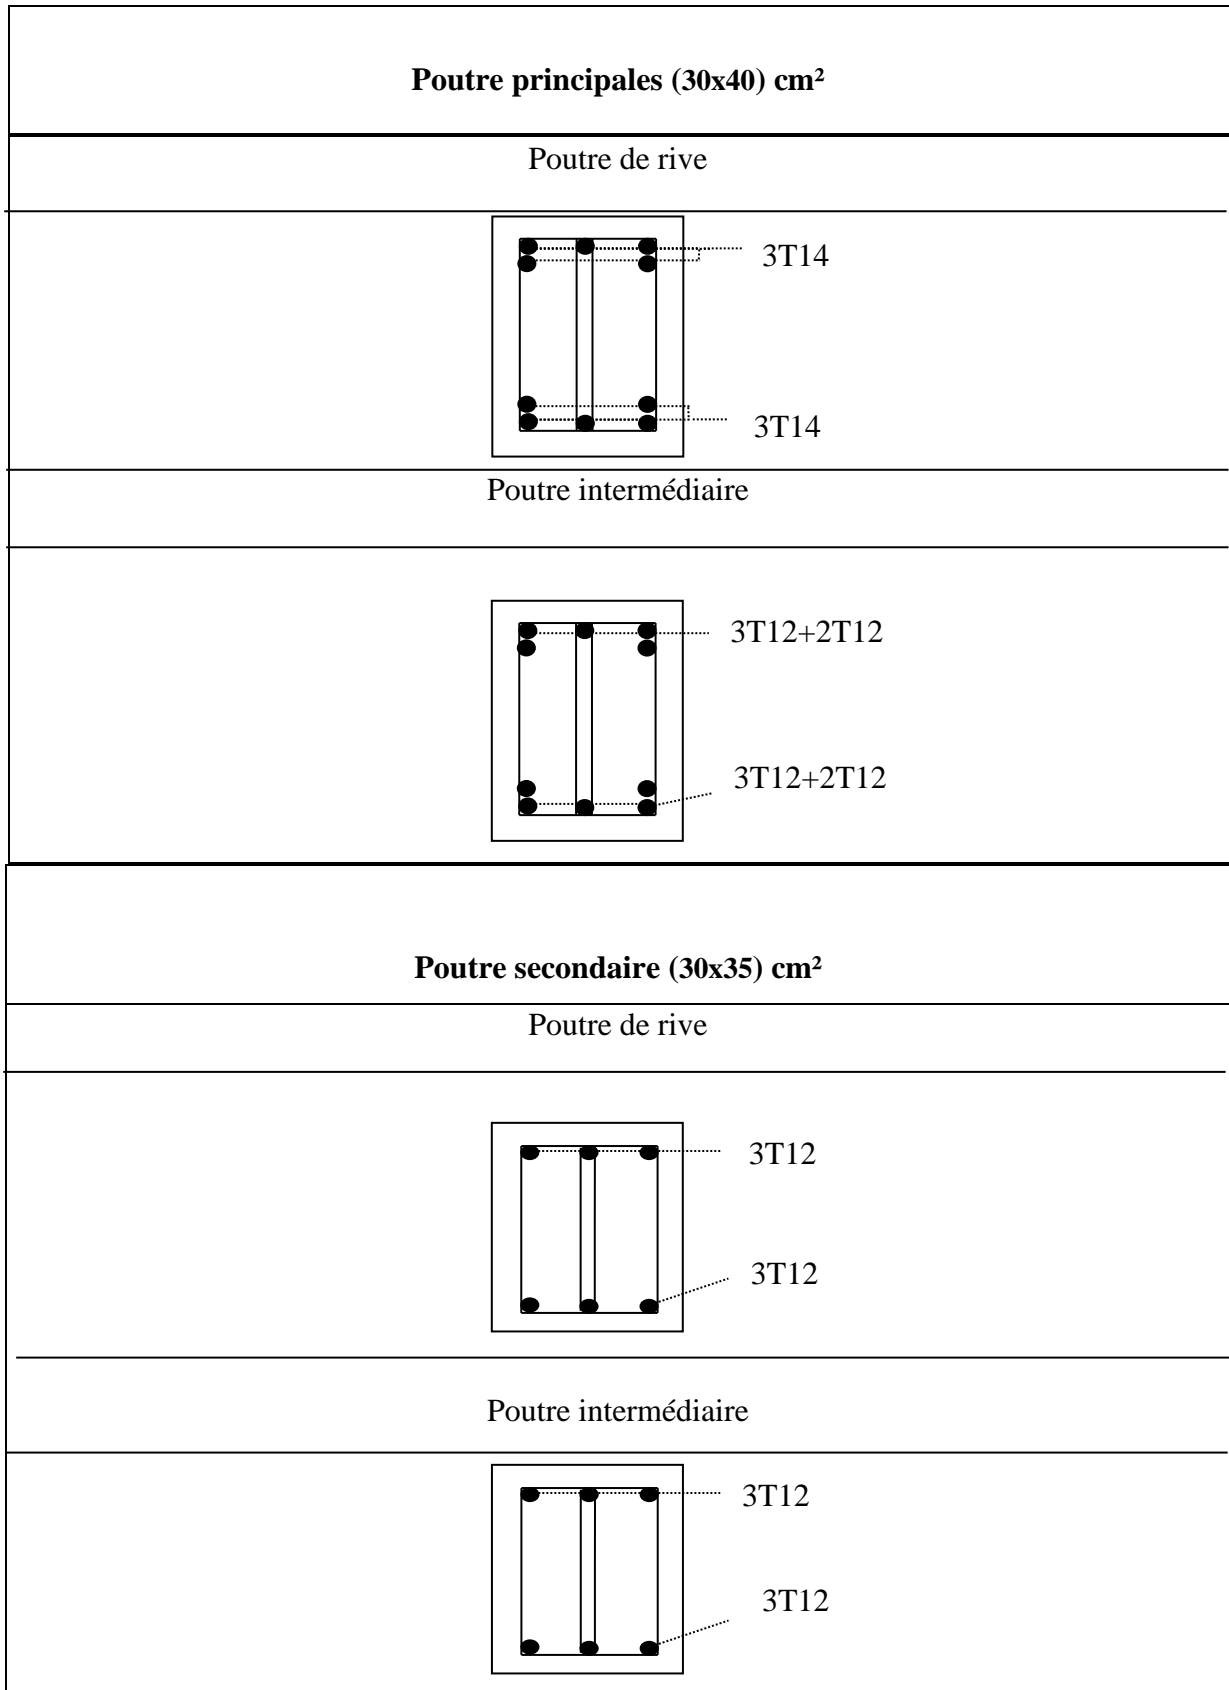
Dessin de ferrailage des sections des poutres principales et secondaires
